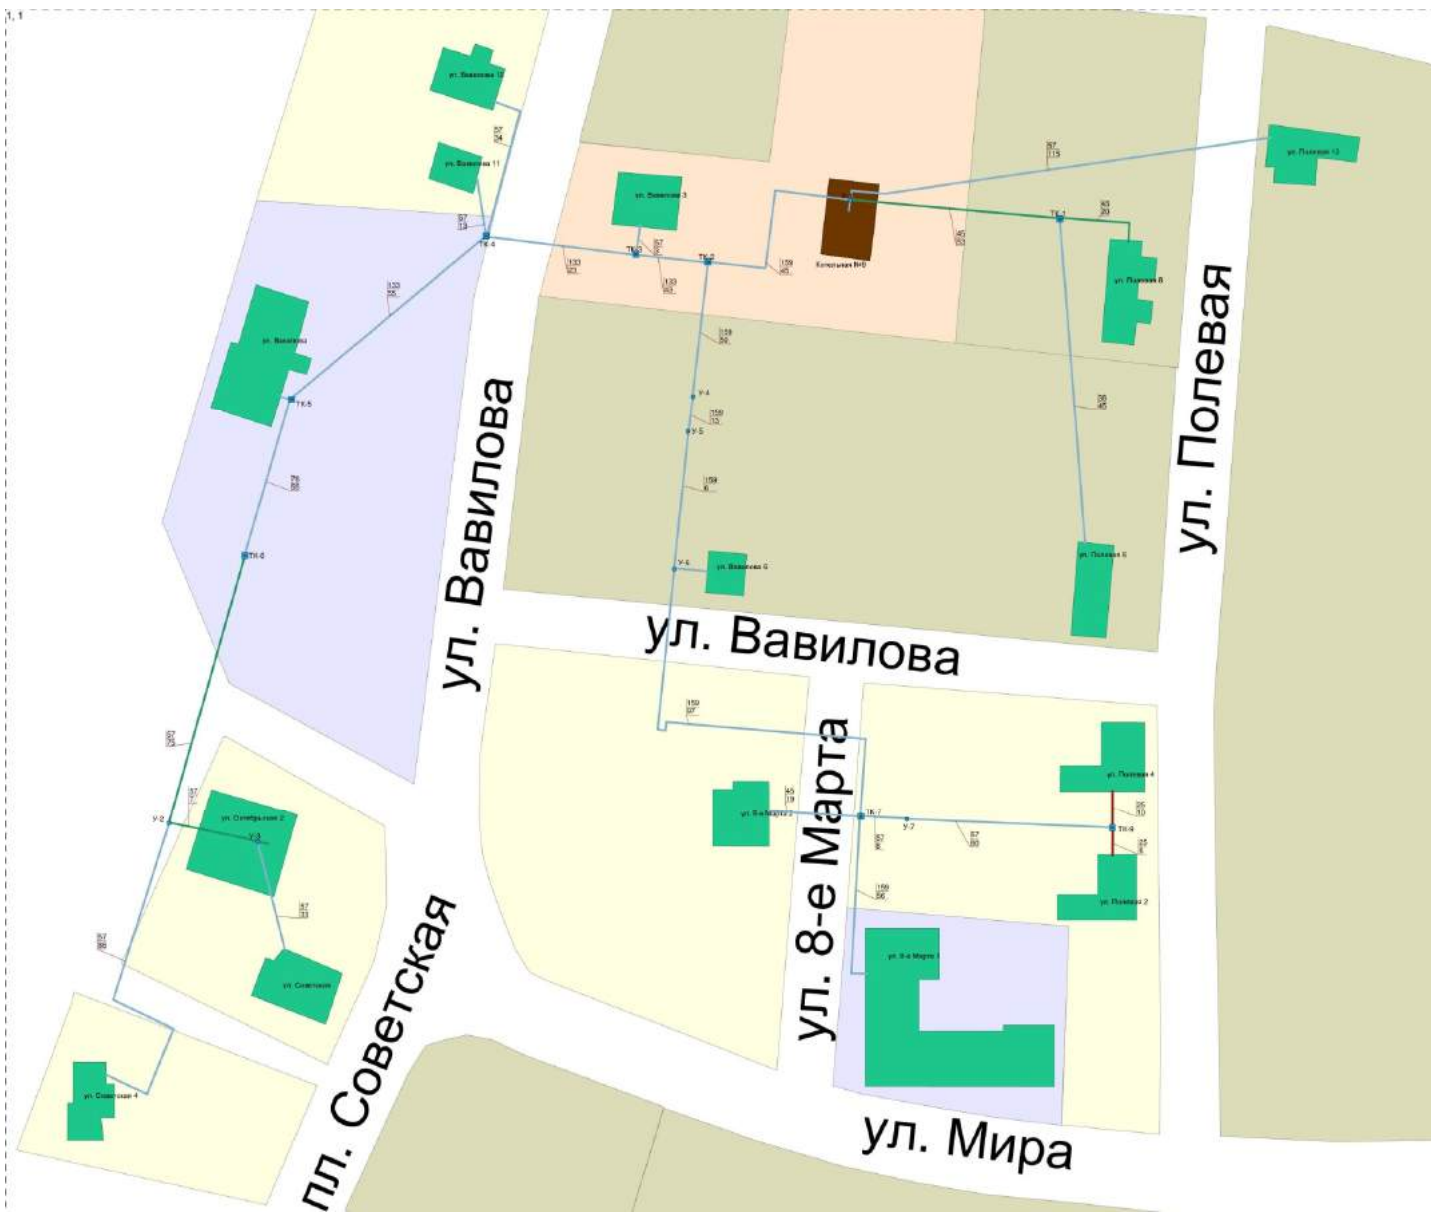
Схема тепловых сетей от котельной № 9 с. Новое село
